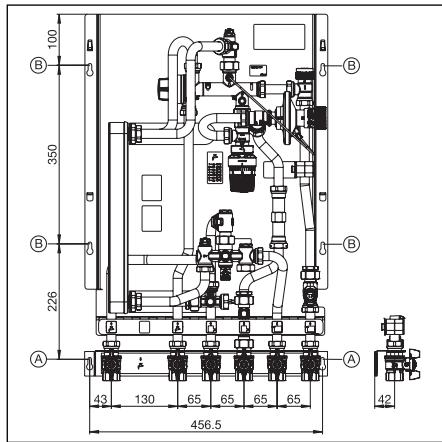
Anschlusschema Kugelhahnanschlussleiste 1341084
